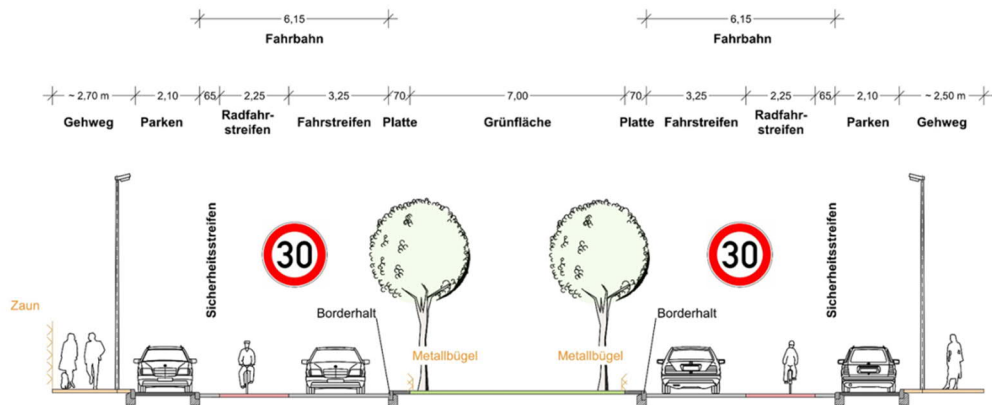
Straßenquerschnitt Planung – Bleickenallee
